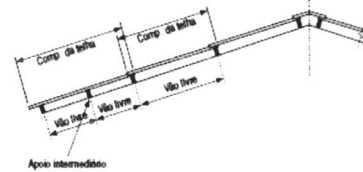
Exemplificação da colocação de apoios e vãos livres em telhas de fibrocimento
